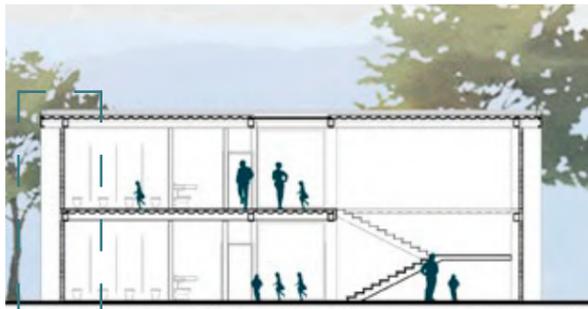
| Sistema constructivo aulario colegio | Fuente: Elaboración Propia
